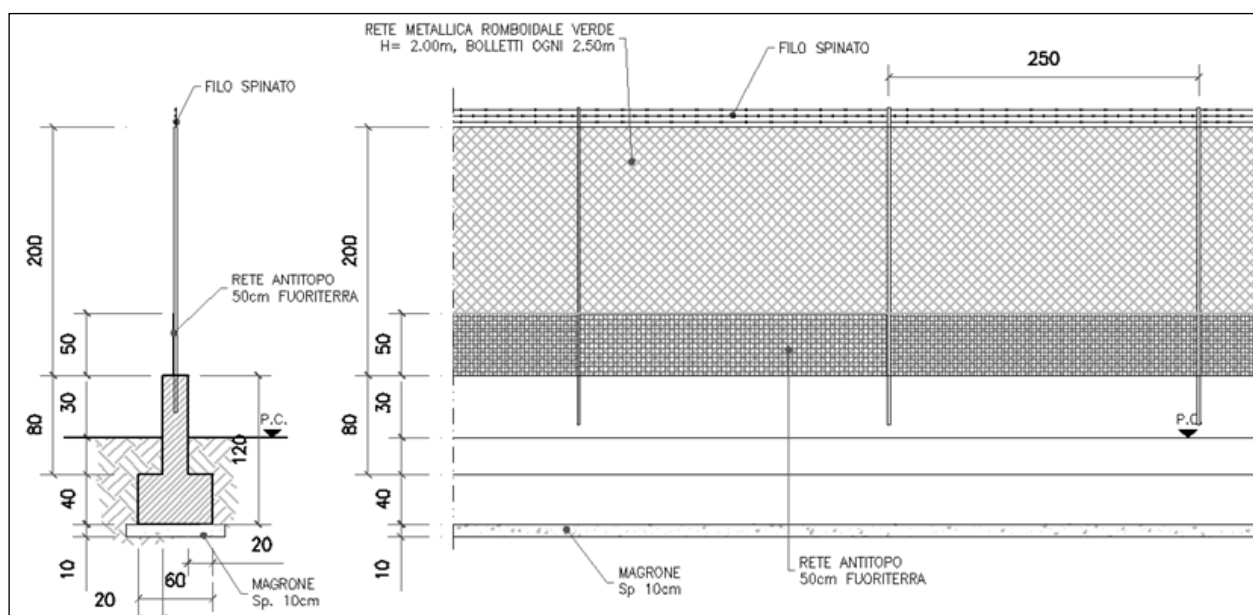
Prospetto e sezione tipologici della recinzione perimetrale
